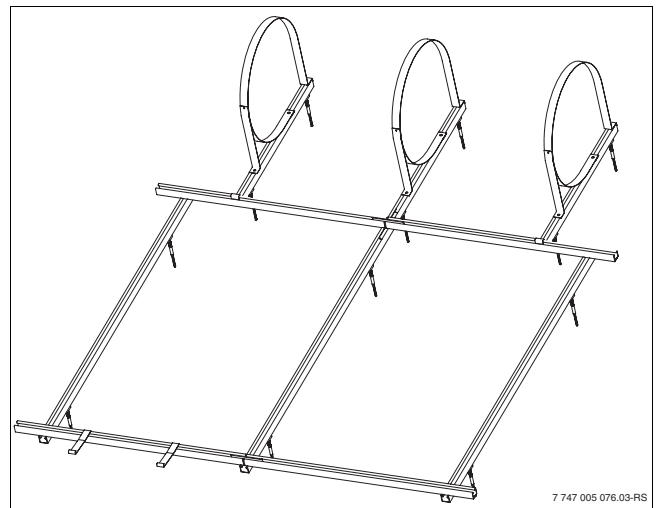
Vista geral da instalação para coberturas de telhados (aqui, sistema de 300 l)
